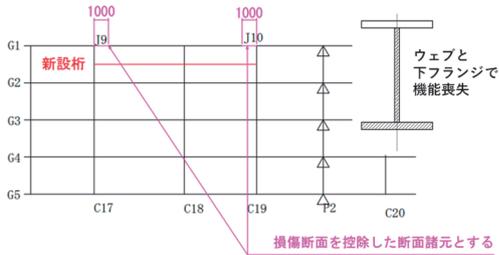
立体格子解析モデルでのG1桁損傷部の扱い（平面図）
